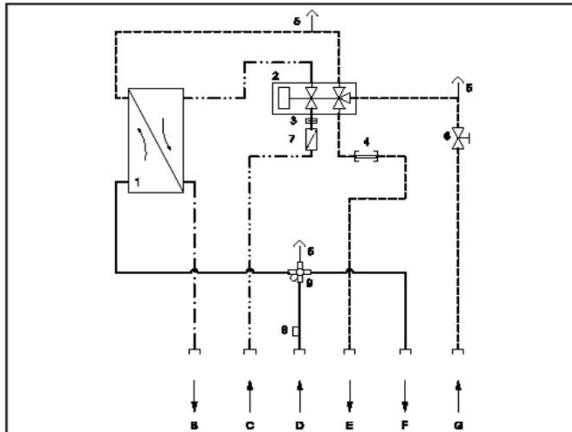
Hydraulikschema - Wohnungsstation (WK) Grundausrüstung (Prinzipdarstellung)
